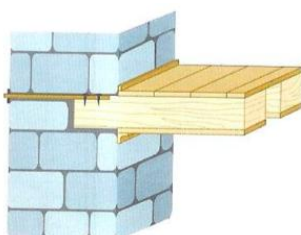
Ancoragem de viga de madeira em alvenaria de pedra [1]
